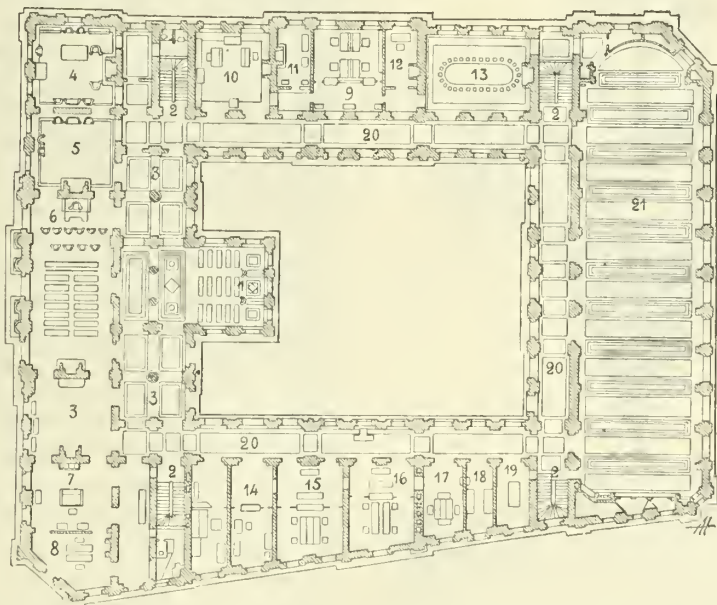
Mairie du IV^e arrondissement de Paris. Plan du 1^{er} étage. 1, escalier principal; 2, 2, escaliers secondaires; 3, 3, salles d'attente; 4, cabinet du maire; 5, cabinet des adjoints; 6, salle des mariages; 7, bureau des mariages; 8, chef de bureau; 9, secrétariat; 10, chef de bureau; 11, sous-chef de bureau; 12, expéditionnaire; 13, salle des commissions; 14, instruction publique; 15, bureau des naissances; 16, ordonnanceur et régleur des pompes funèbres; 17, bureau des décès; 18, porteurs des pompes funèbres; 19, buvette des employés; 20, 20, galeries; 21, salle des fêtes.
